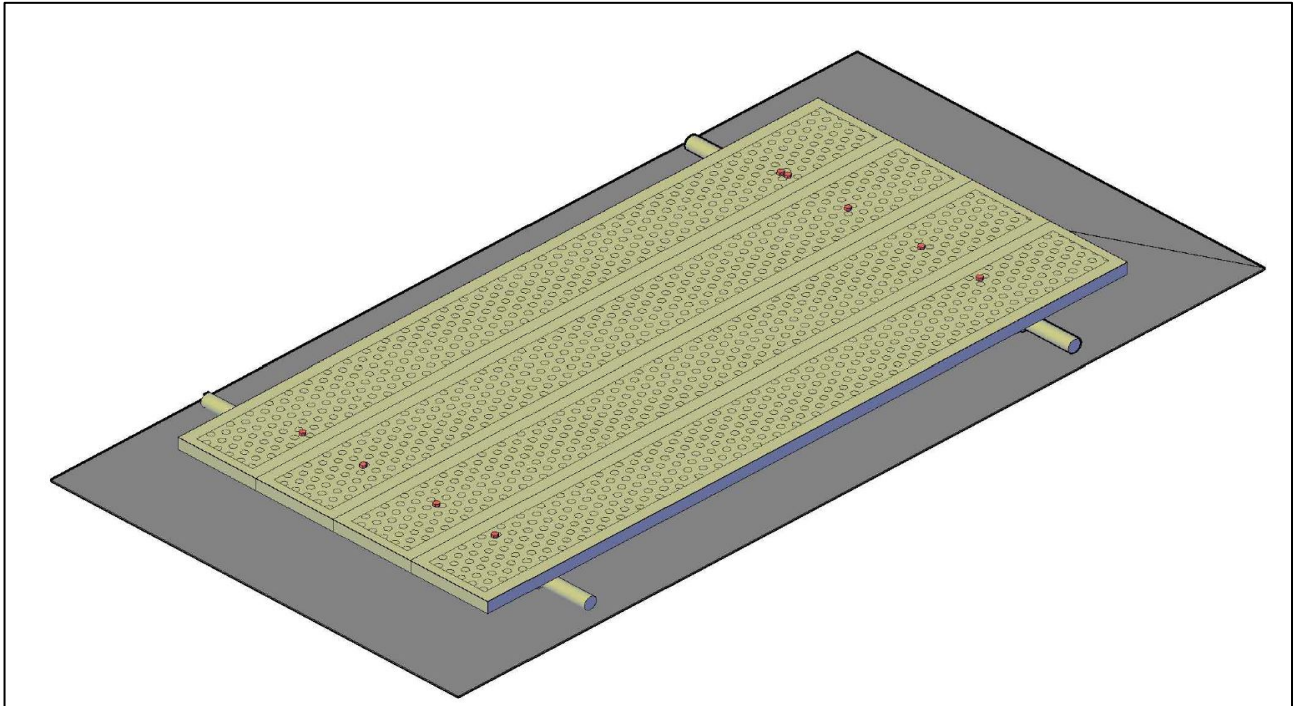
Изометрический вид инвентарного перекрытия проемов без использования сварных соединений
